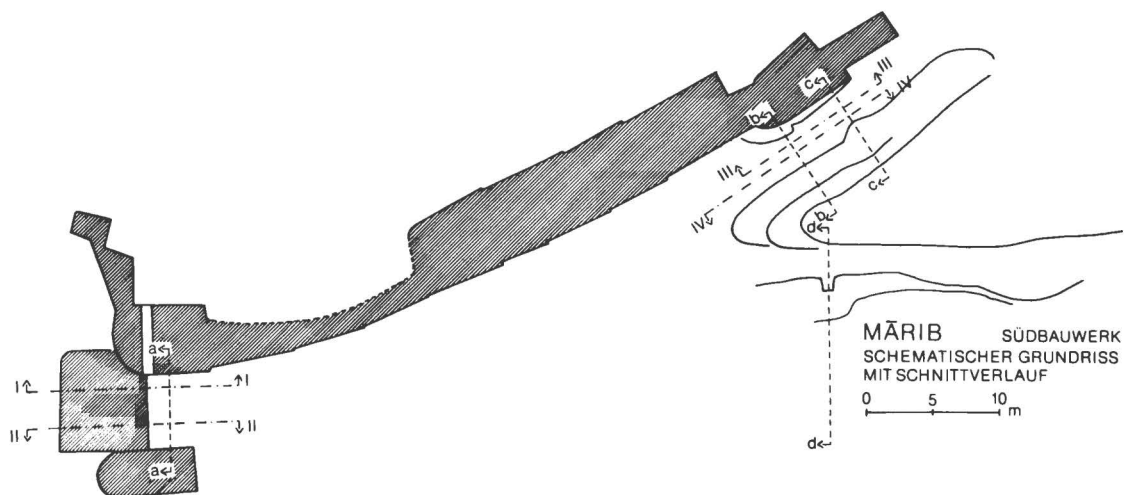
Märib, Damm. Südbauwerk. Schematischer Grundriß mit Schnittverlauf.
